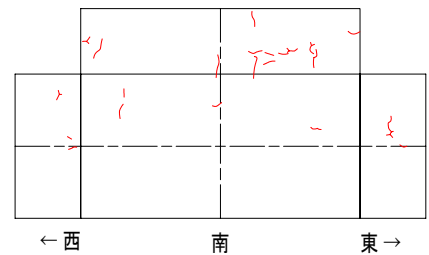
model-c(鉄筋比 0.36%)のひび割れ状況
